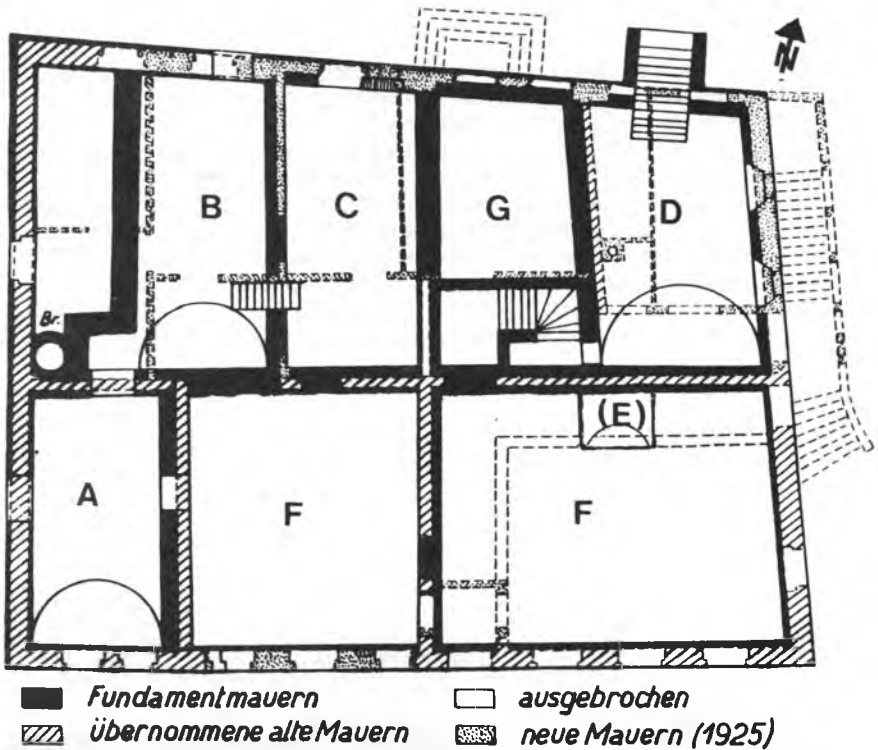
Plan des Gasthauses "Krone" (Umbau 1925) mit den Gewölbekellern A, B und D. M. 1:200. – Keller E wurde erst bei der Bauaufnahme und den Aushubarbeiten dokumentiert und im Plan ergänzt<sup>1</sup>.
